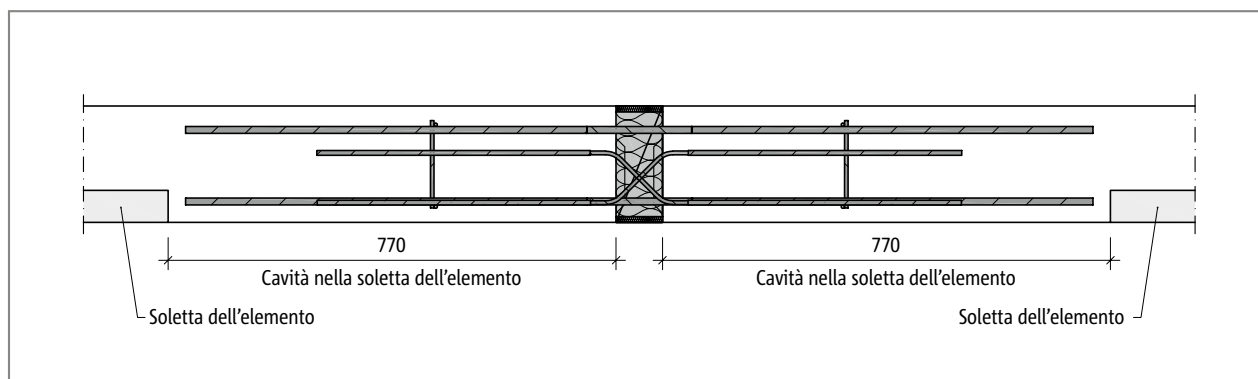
Schöck Isokorb® T tipo DL: solaio dell'elemento con cavità e Isokorb® T tipo DL
